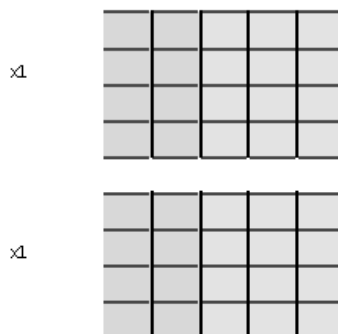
(Continuación). Plan para ensamble de estructura muros curvos.
